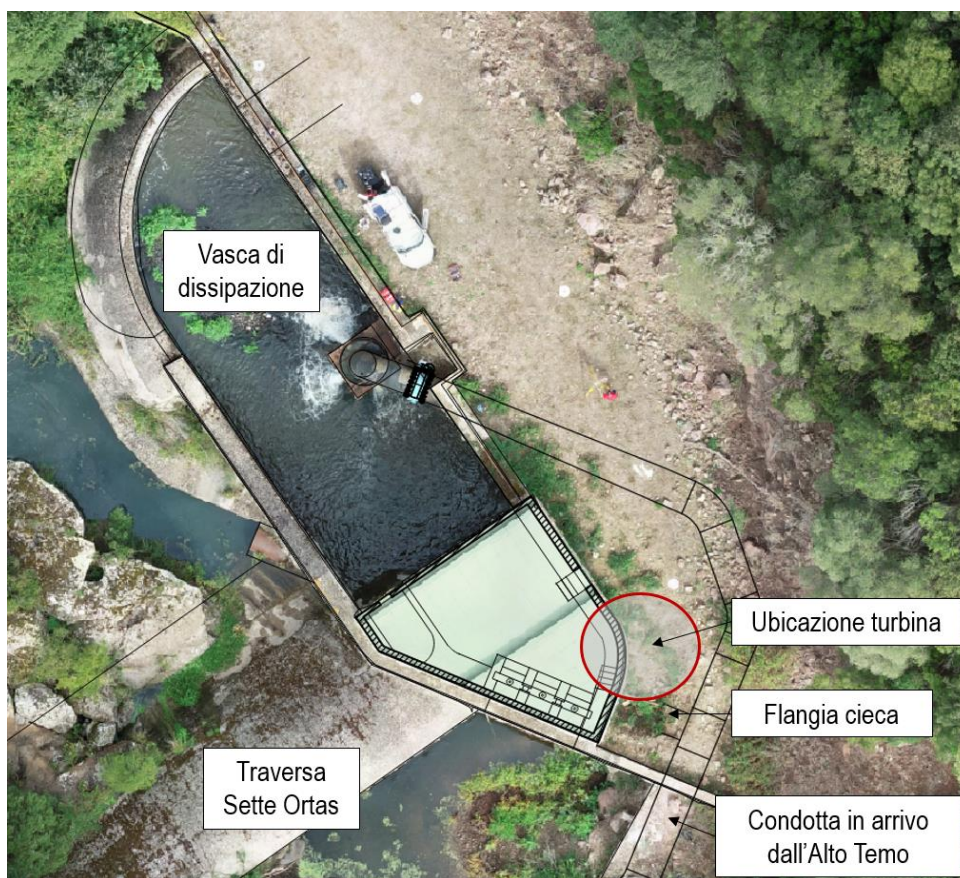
Planimetria dell'edificio esistente e manufatti esistenti
